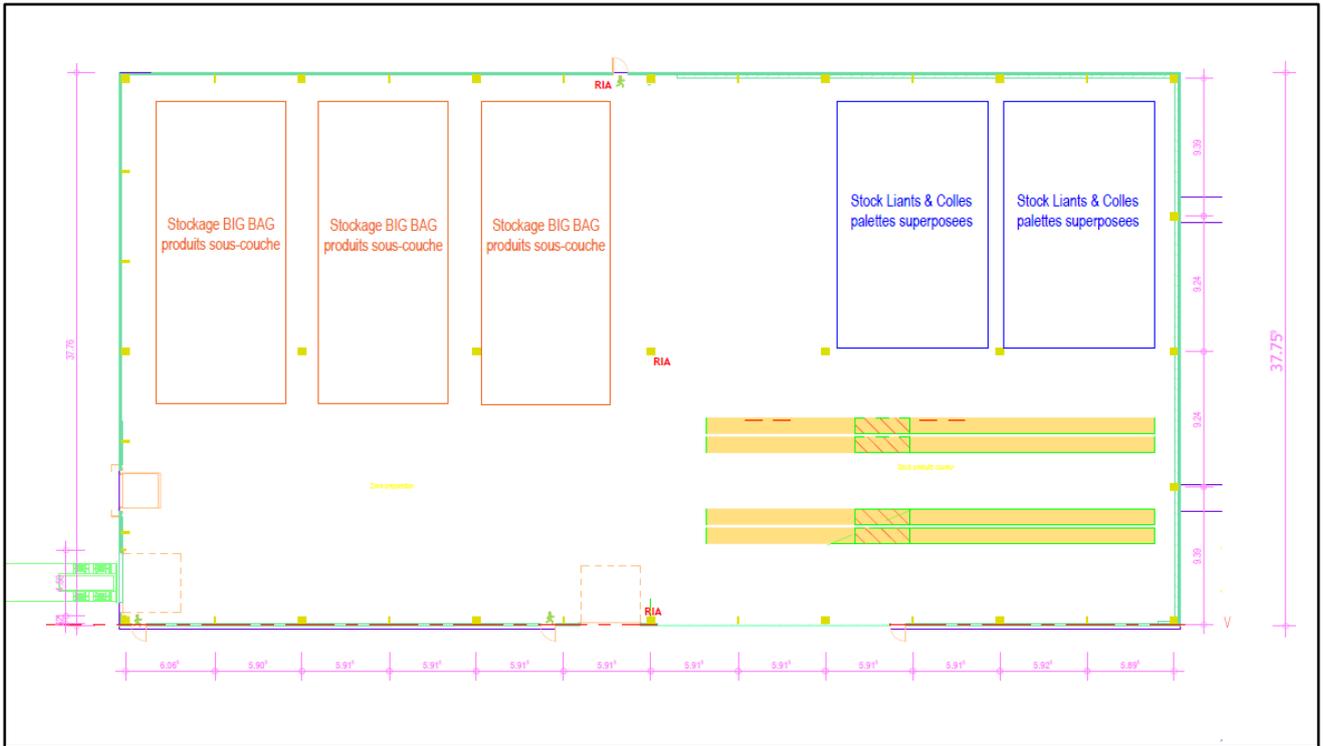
Stockage futur bâtiments (source : sicabconstruction)
